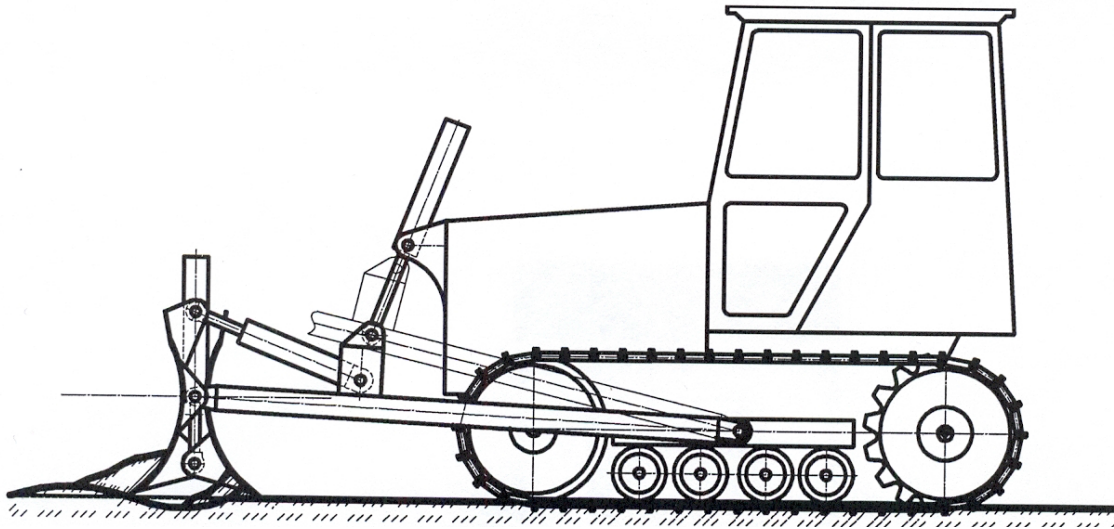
Предварительная планировка поверхности движением бульдозера вперед
